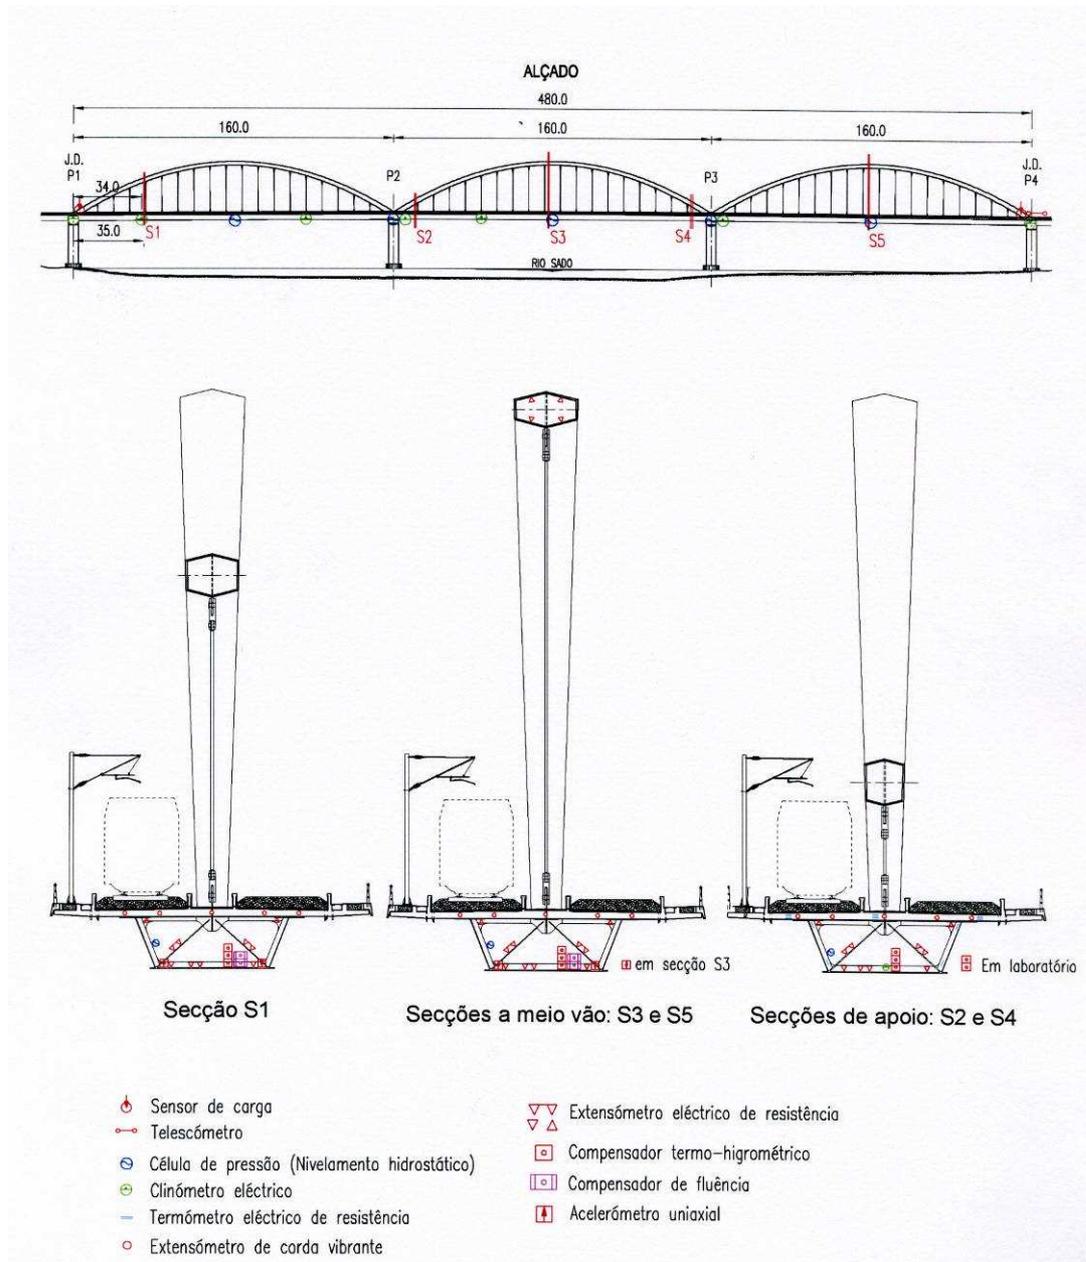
Plano de observação da ponte ferroviária sobre o rio Sado
